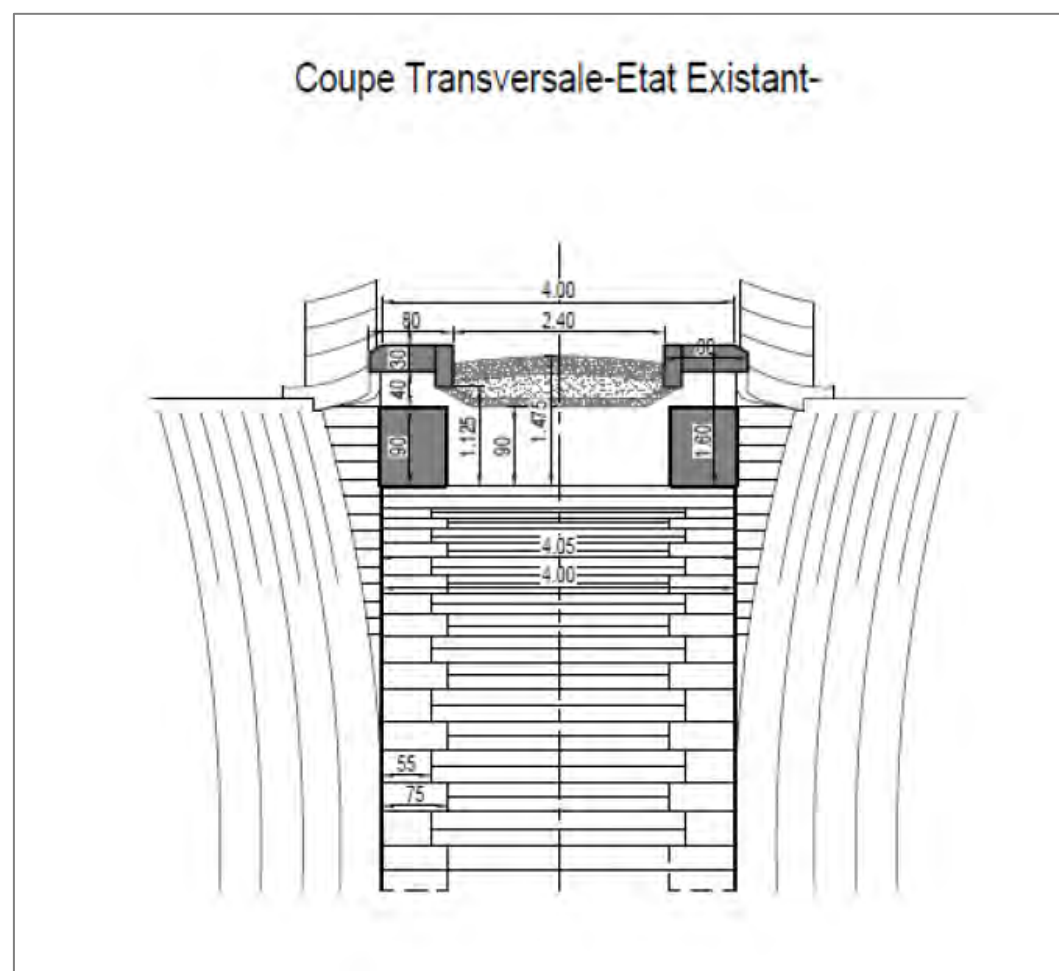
Coupe transversale type du pont existant « route des Volières »
